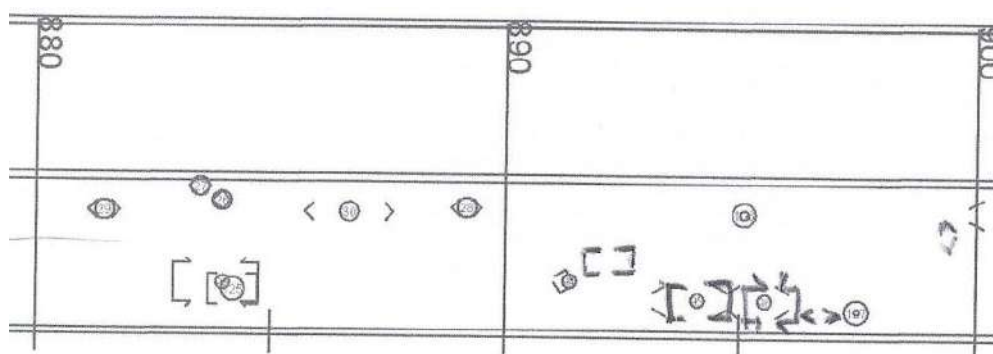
Exemplo de planta de defeitos dos pavimentos (DNIT, 2017)
